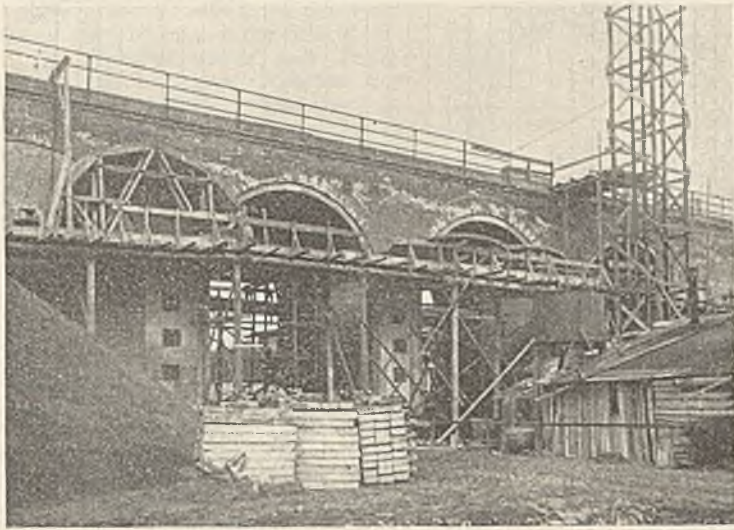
Viadukt Kláham. Fertige erste Brückenhälfte.
